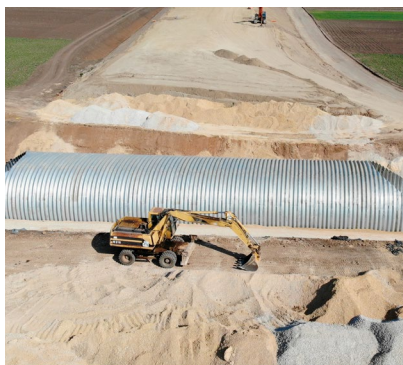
Forbindelse mellem korrugeret stål bue og betonfundament
